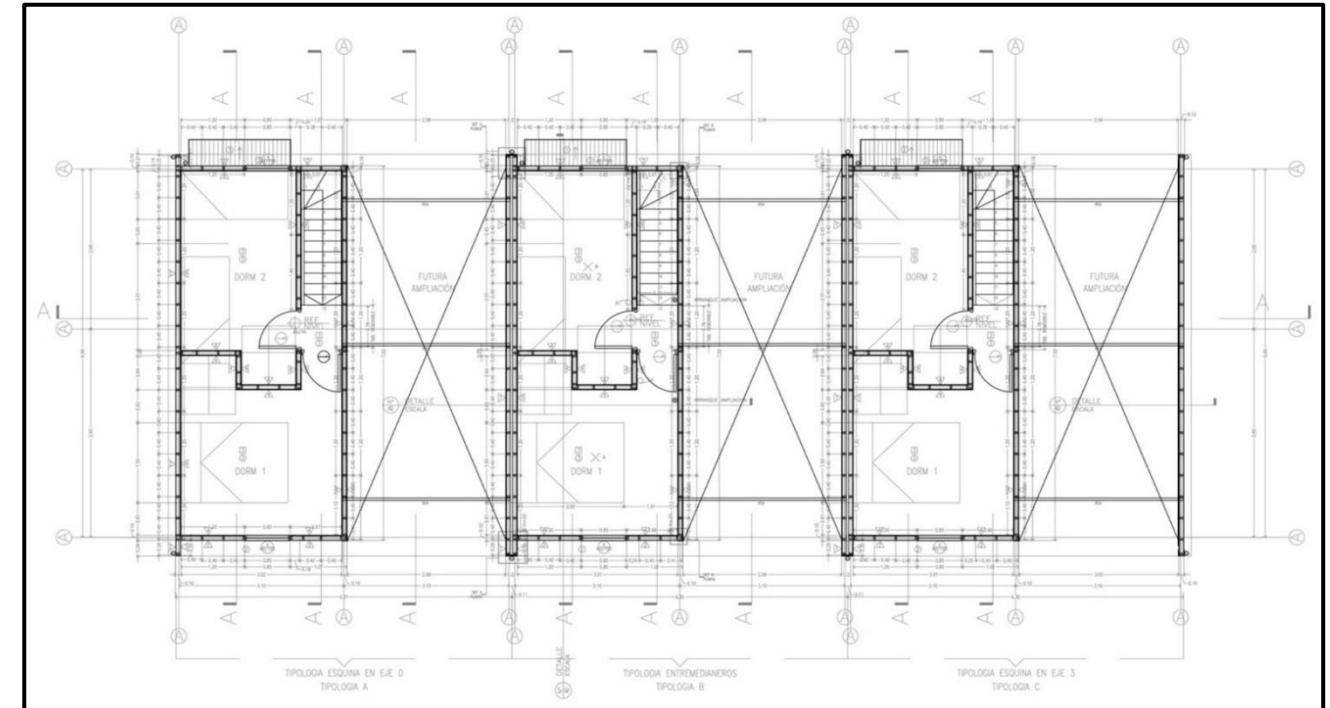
Planta Segundo nivel- Propuesta vivienda progresiva en Chile.
